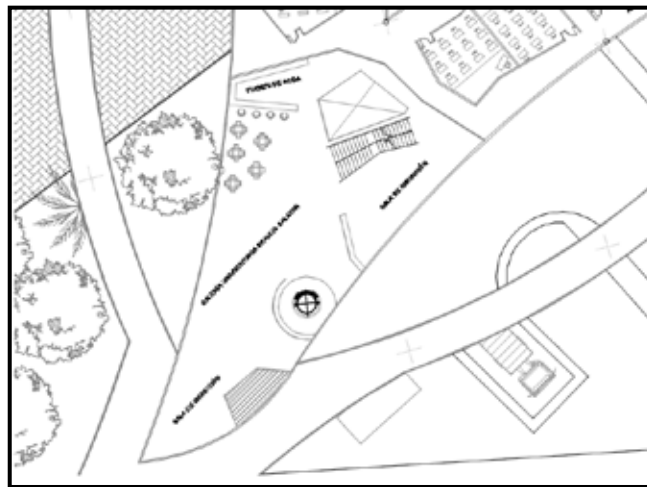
Núcleo “C” Galería nivel +6,00m. (2017)
